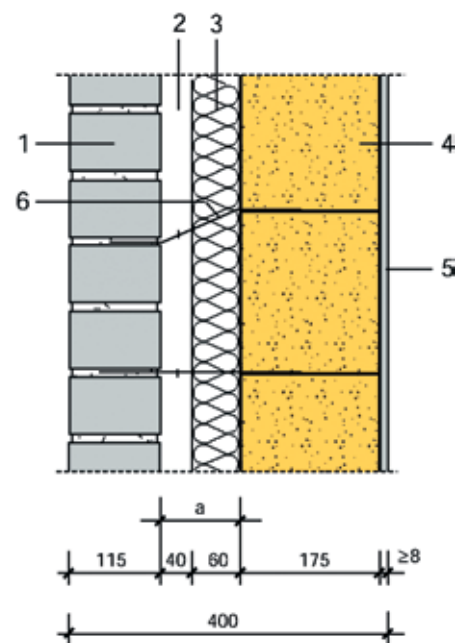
Облицовка кирпичом керамическим с теплоизоляцией при наличии вентилируемого воздушного зазора: 1 – облицовочная стена из кирпича, 2 – вентилируемый воздушный зазор, 3 – теплоизоляция, 4 – стена из газобетонных блоков, 5 – внутренняя штукатурка, 6 – анкер
